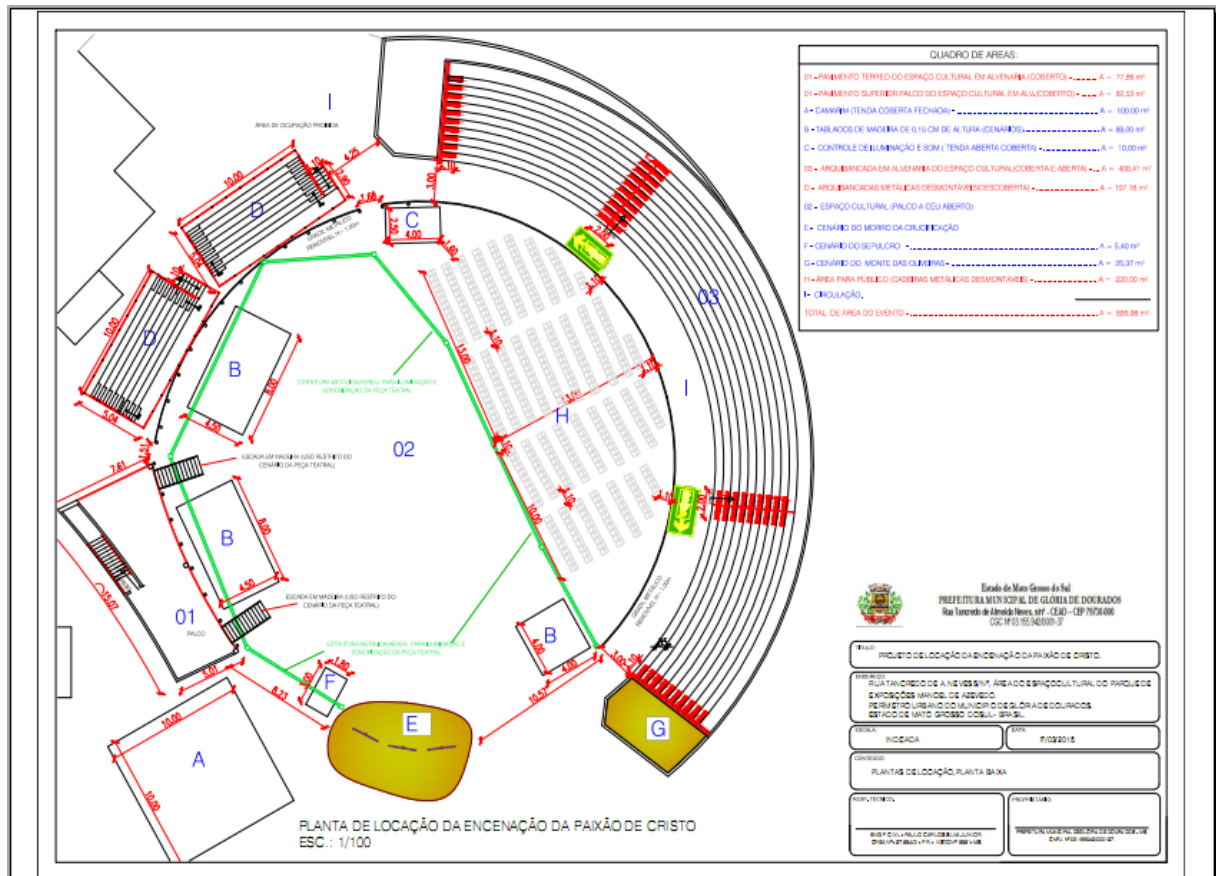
PLANTA BAIXA: PROJETO DE LOCAÇÃO DO ESPETÁCULO PAIXÃO DE CRISTO 2015
